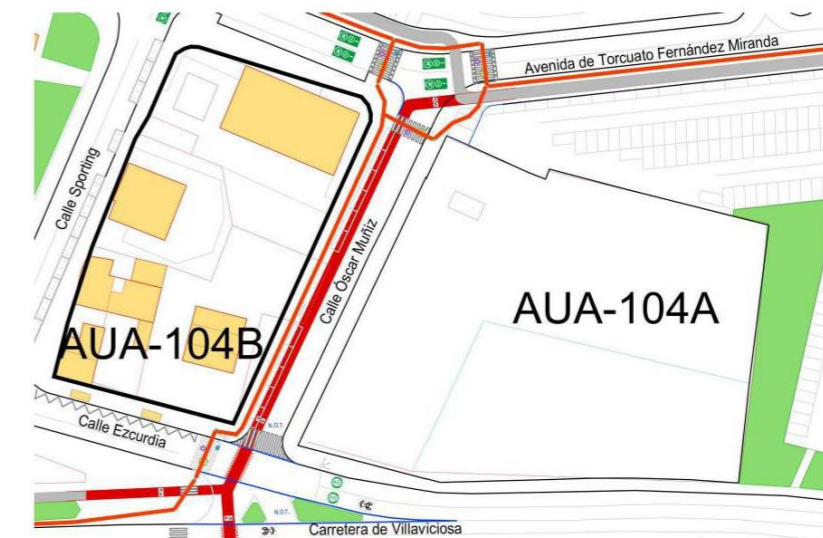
Plano detalle de la actuación propuesta en el entorno de la Calle Óscar Muñiz
